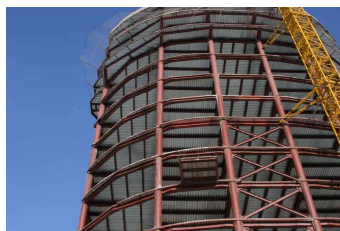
Возведение каркаса здания с применением трубобетонных колонн: подземная и надземная части здания
